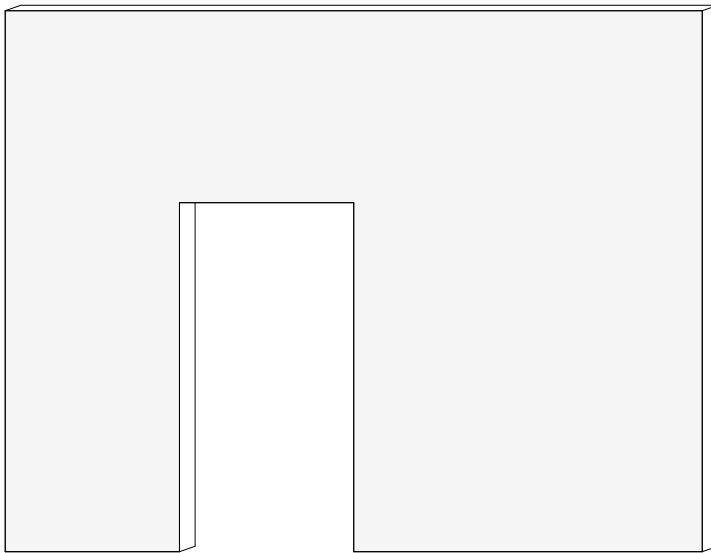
Stahlbetonwand 3D-Darstellung²¹²
